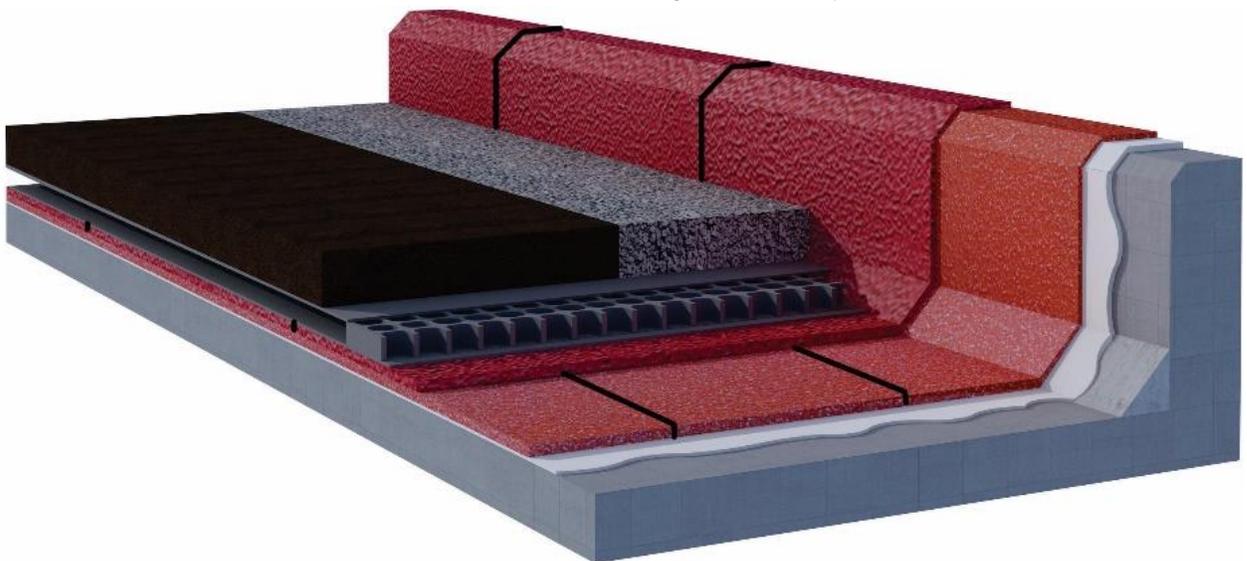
Pretil perimetral cubierto con impermeabilizante y pendiente sobre el soporte estructural
